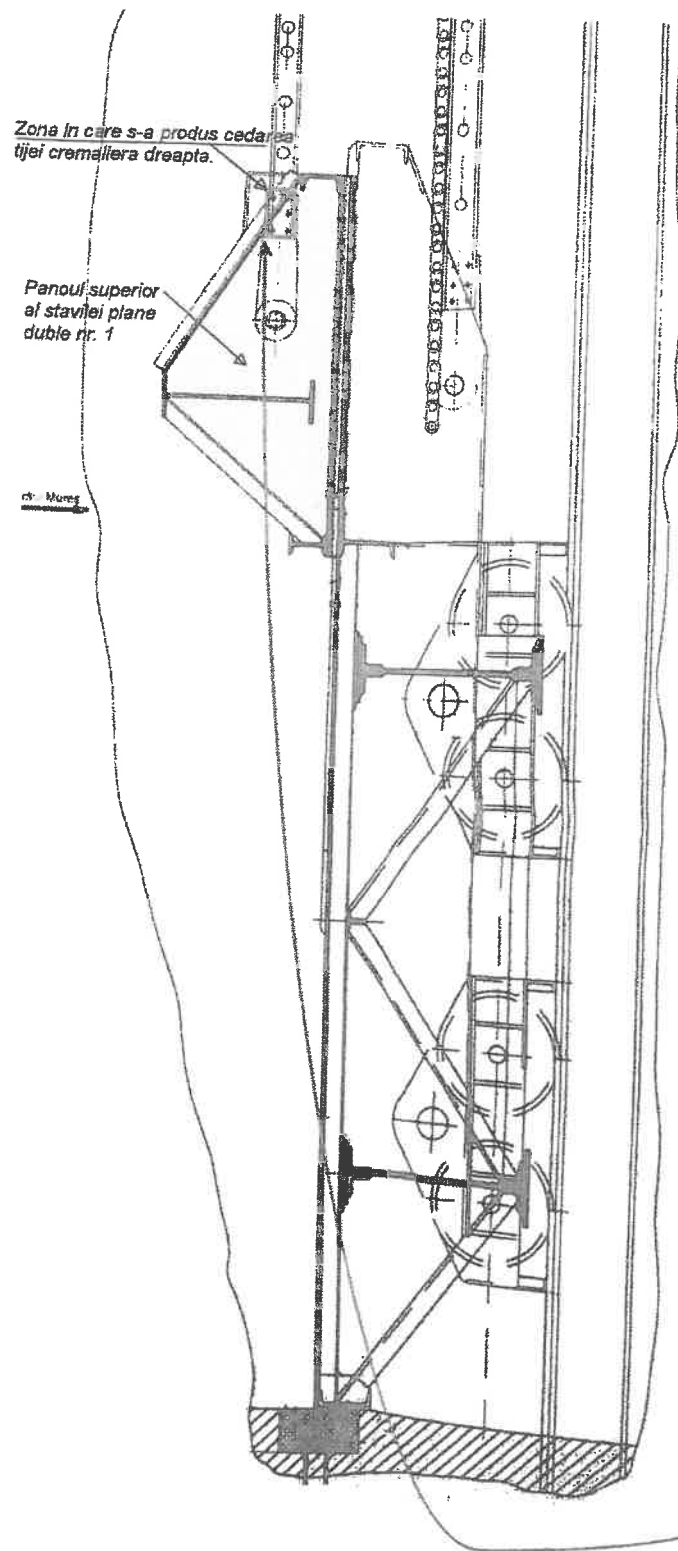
Secțiune verticală prin stavila plană dublă, cu evidențierea panoului superior și a zonei de cedare.
